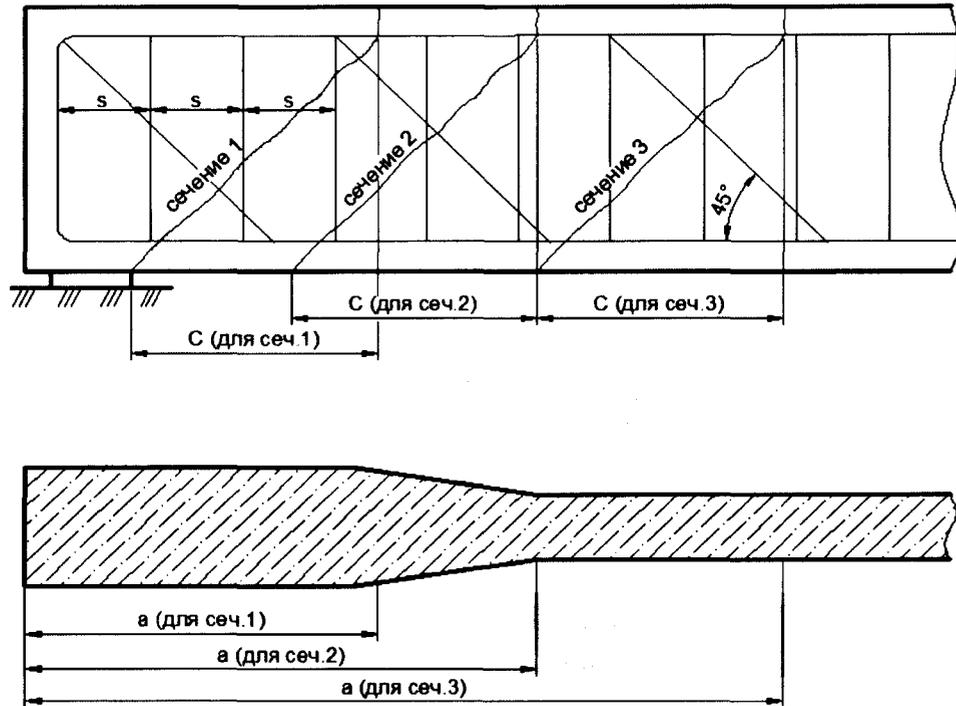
Схема для расчета наклонного сечения по прочности
